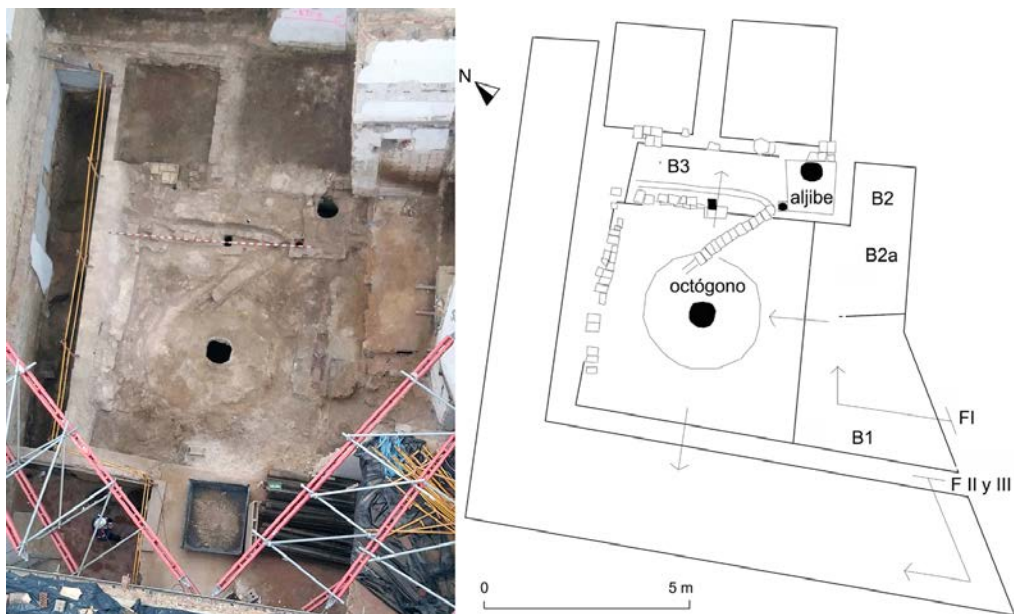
Final de la excavación de la planta baja y aljibe (Foto Basilio Muñoz Cambrón) y fotorestitución. Circulación interna del sótano y localización de los accesos en las fases I, II y III.
